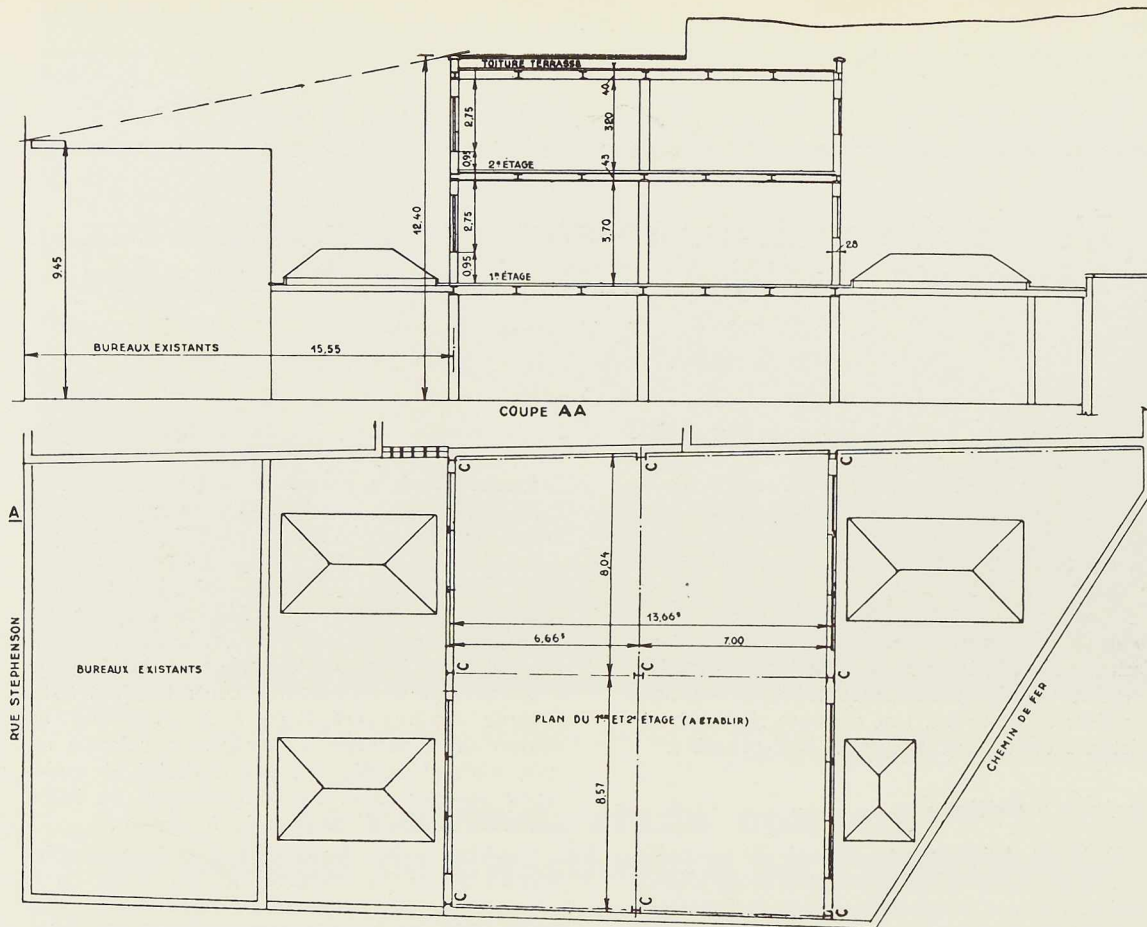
Plan et coupe longitudinale des nouveaux bâtiments (C, colonnes).
